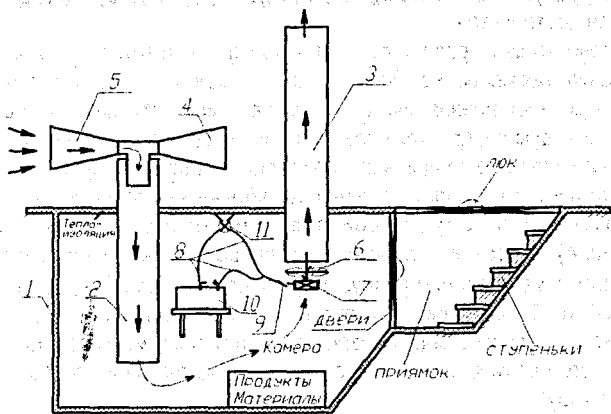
Холодильная камера в грунте без освещения (патент РБ №5073)
